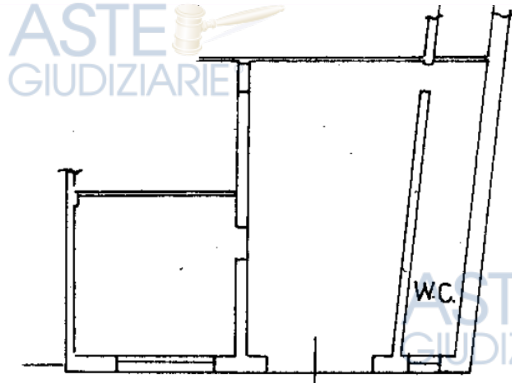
Confronto pianta piano terra sub. 2 Comune di Teggiano
